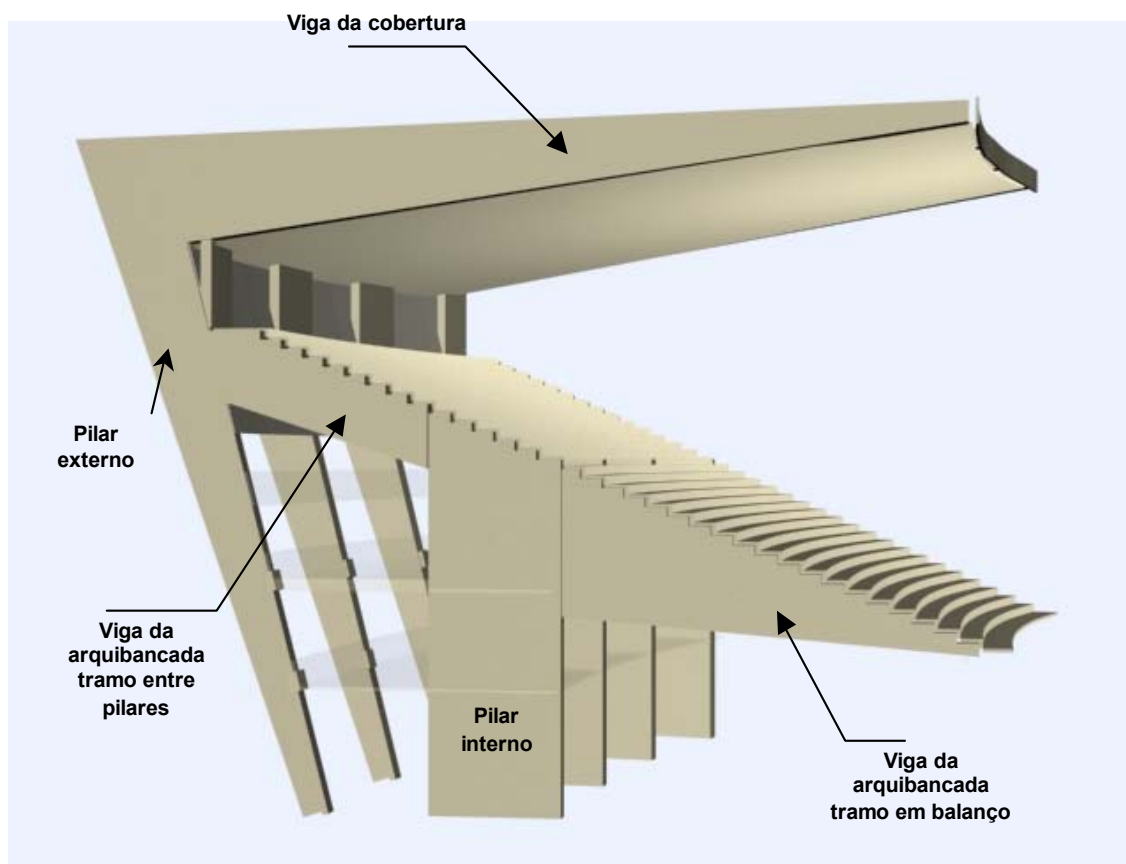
Croquis com a localização da viga e lajes da arquibancada, pilares externo e interno
